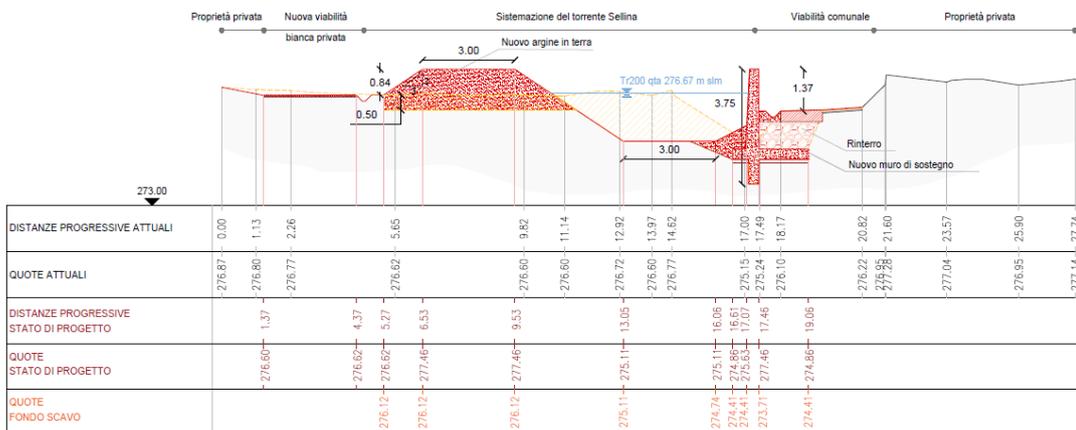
estratto della tavola T03a del progetto - Sezione 2403.60
